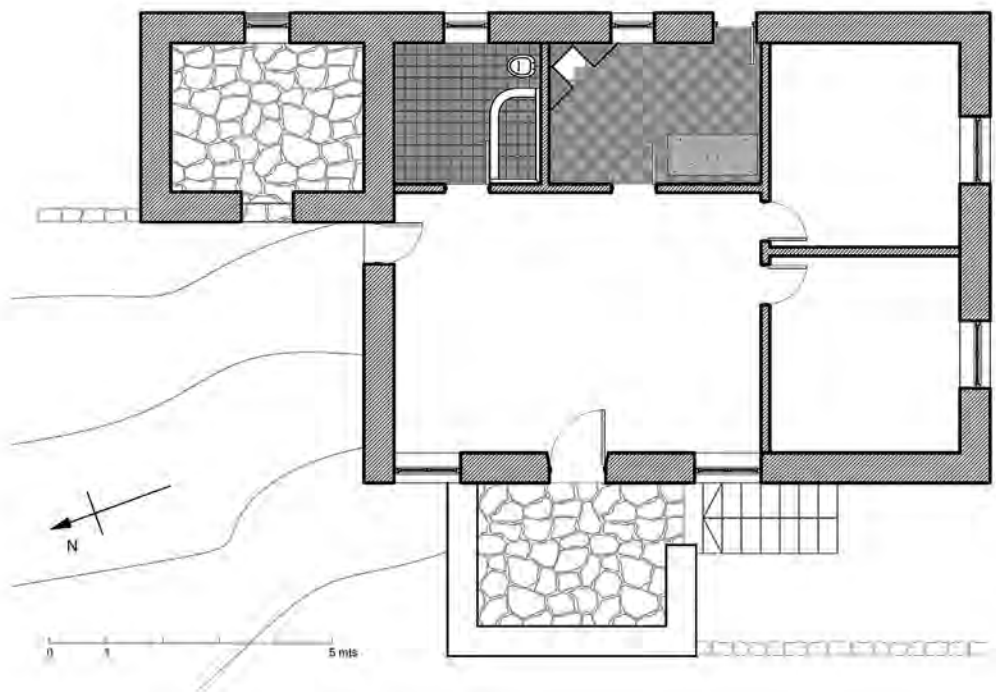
Planta de la Estructura I, los muros externos de piedra, los internos de ladrillos y las usadas para delimitar el camino de acceso y el patio posterior.
